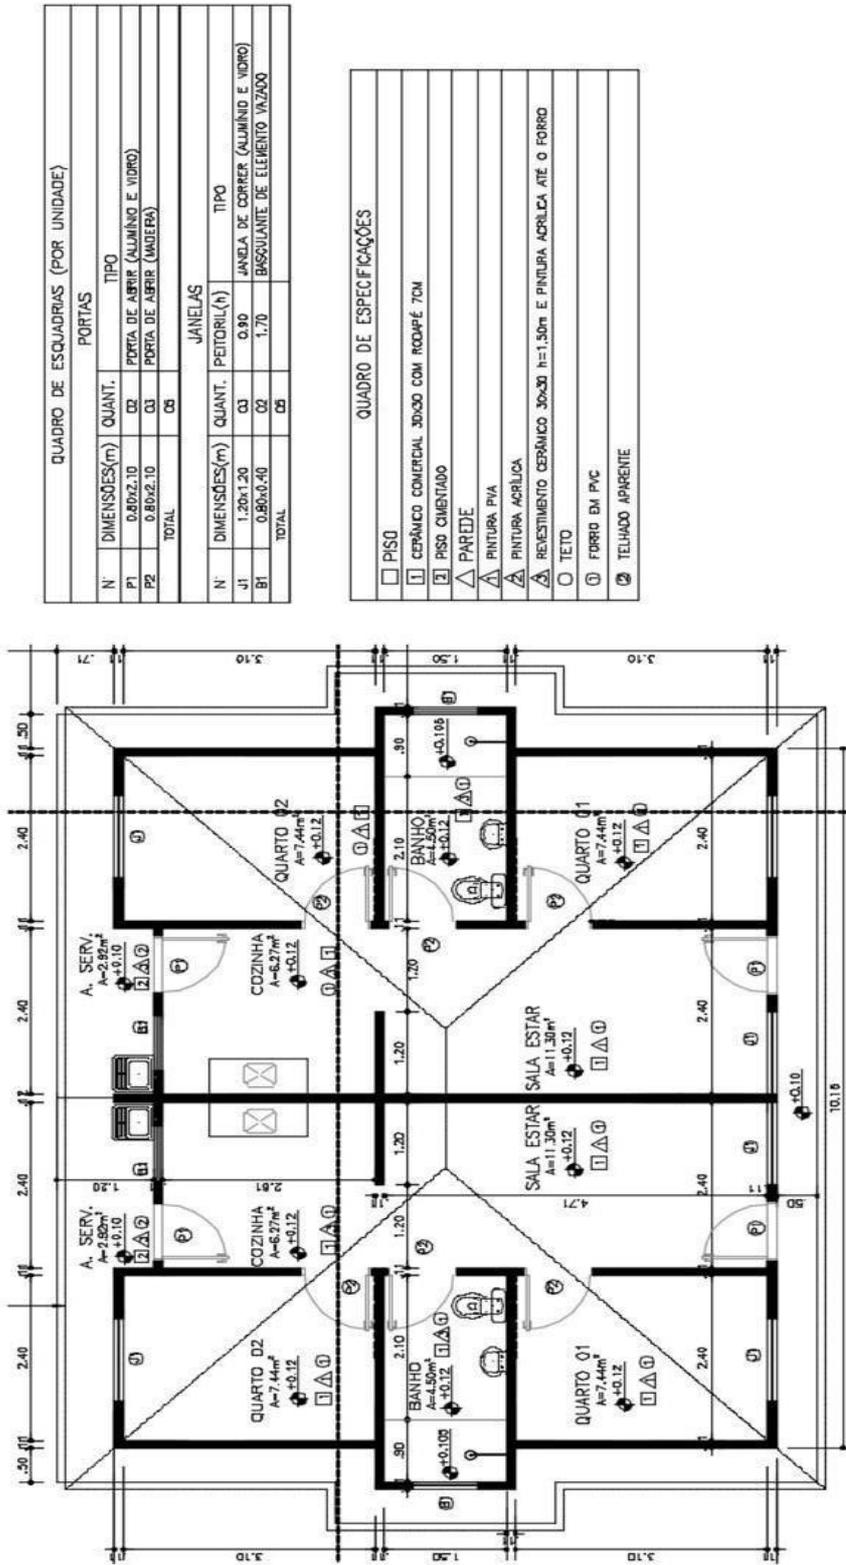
Planta baixa e Planta de Layout das casas do Residencial Ribeira.
